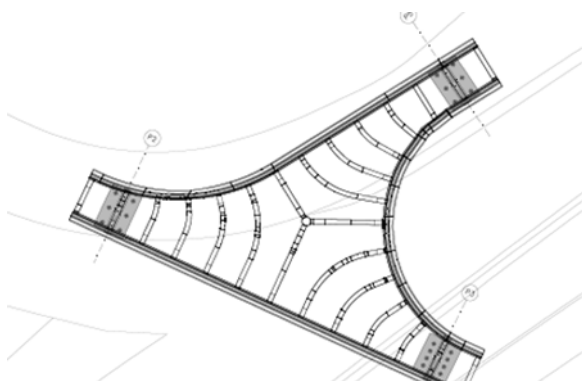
Estructura vista en planta de la zona de la plaza de la pasarela.
